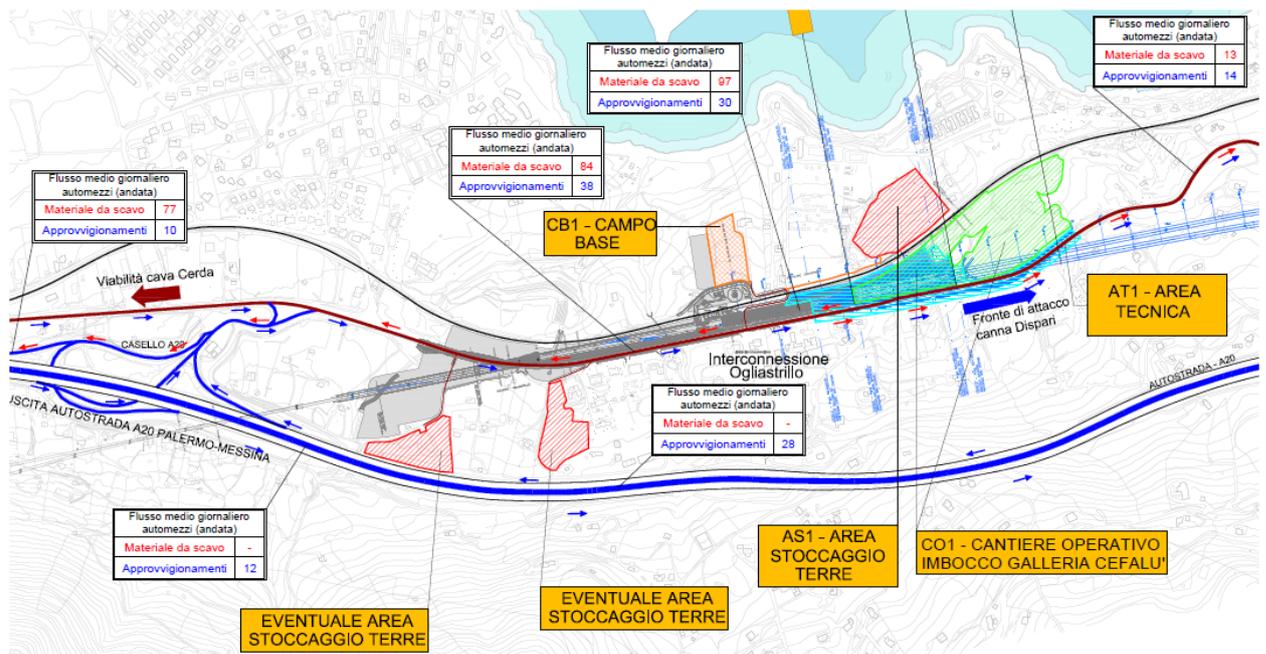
Stralcio planimetria dei flussi area Ogliastrillo
